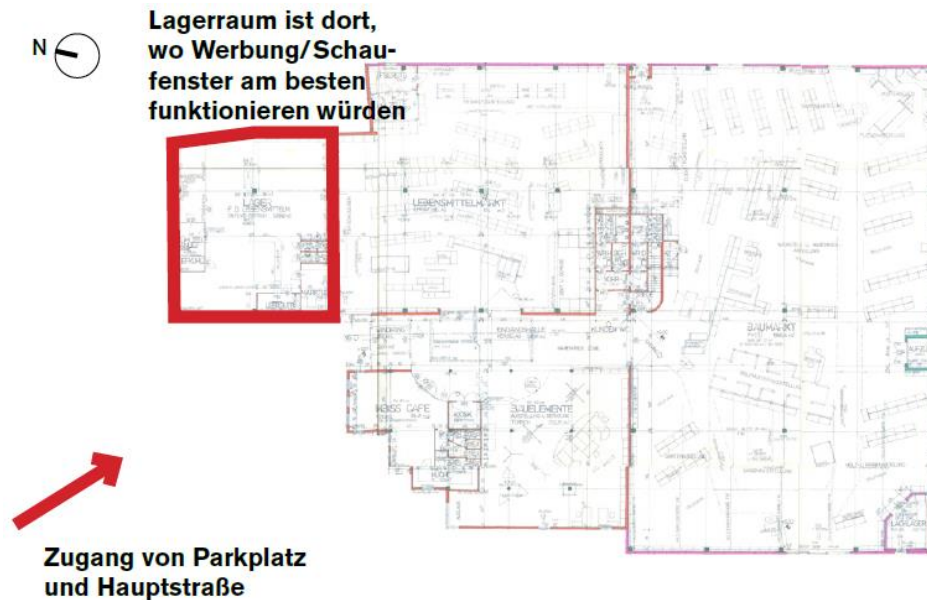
Plan der Zielpunktfläche mit Markierung der nicht zufriedenstellenden Zugangssituation (Architekturbüro nonconform, 2017)
